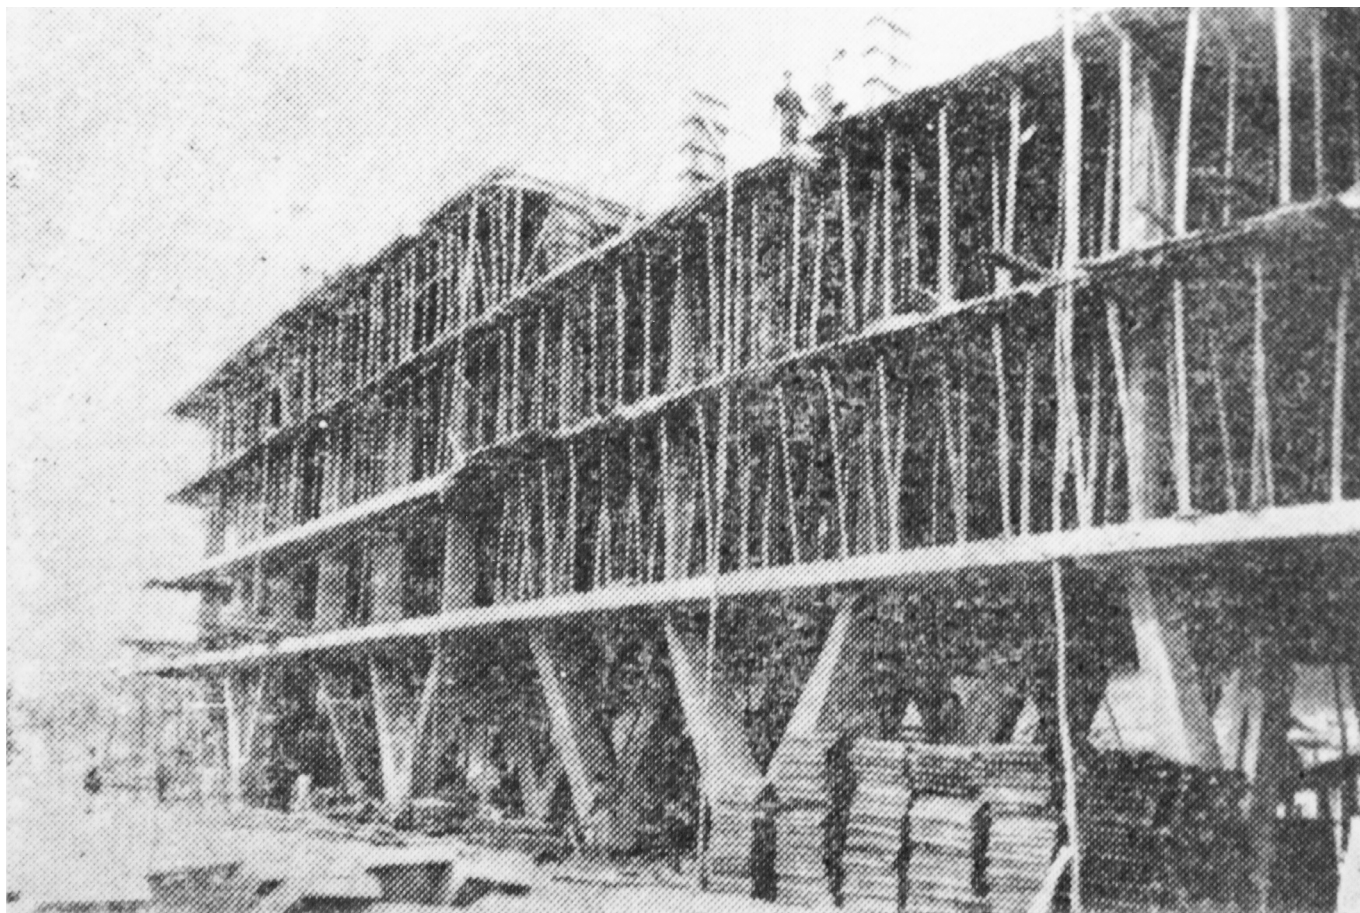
Residencia Universitaria (1961). Foto de proceso de construcción. Emplazada en la parte Norte del lote, Su horizontalidad, materialidad, sistema de construcción, de planta baja libre con un sistema portante de columnas en V encargada de soportar la estructura del edificio, lo llevan a ser un referente gran arquitectónico nacional. Al igual que sus predecesoras, prevalece la horizontalidad de la verticalidad; es considerado un hito dentro de la planificación ya que este edificio delimita la circulación peatonal, se encuentra en la cima de todo el Campus y es la edificación que sobresale por su altura.
